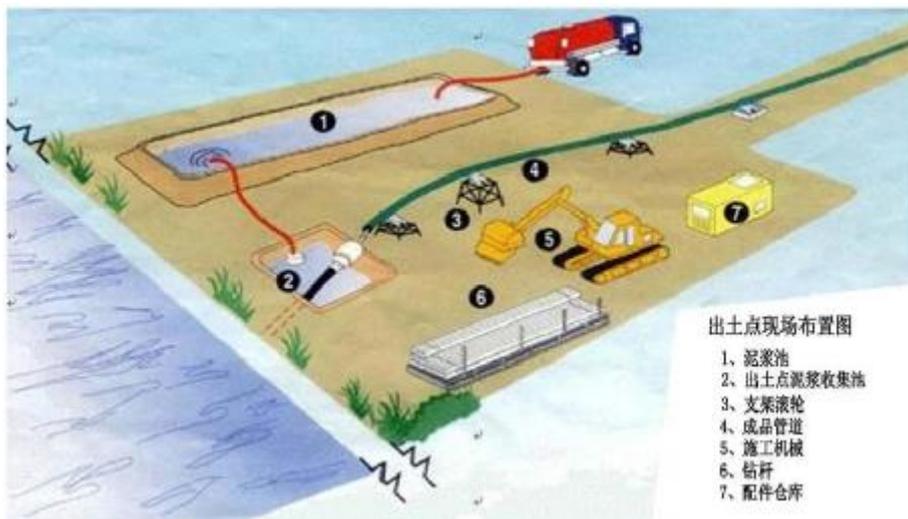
定向钻施工场地布局示意图 (出土点)
